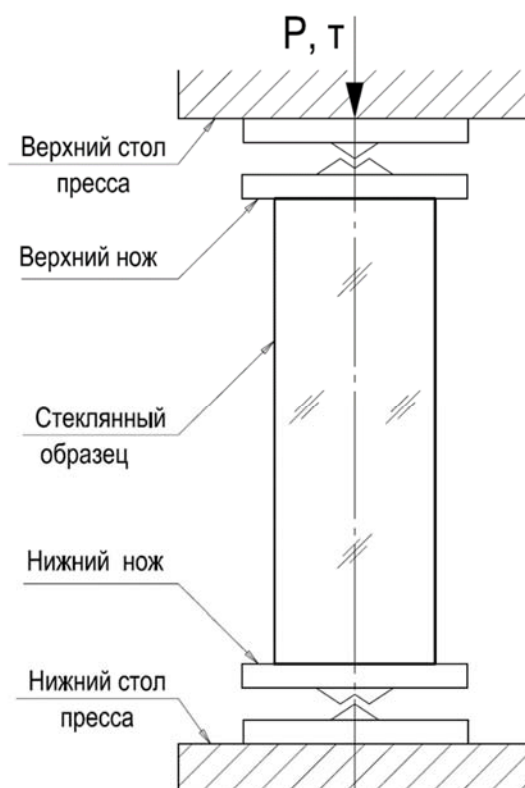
Схема приложения сжимающей нагрузки на испытательном стенде
